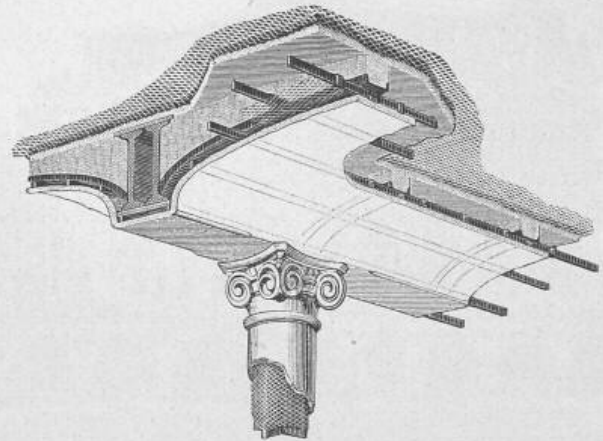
Kassettierte Decke mit Streckmetallbeton.
